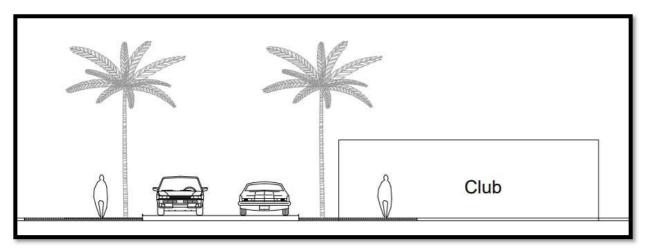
Sección transversal tramo 2. Fuente: Elaboración propia.
